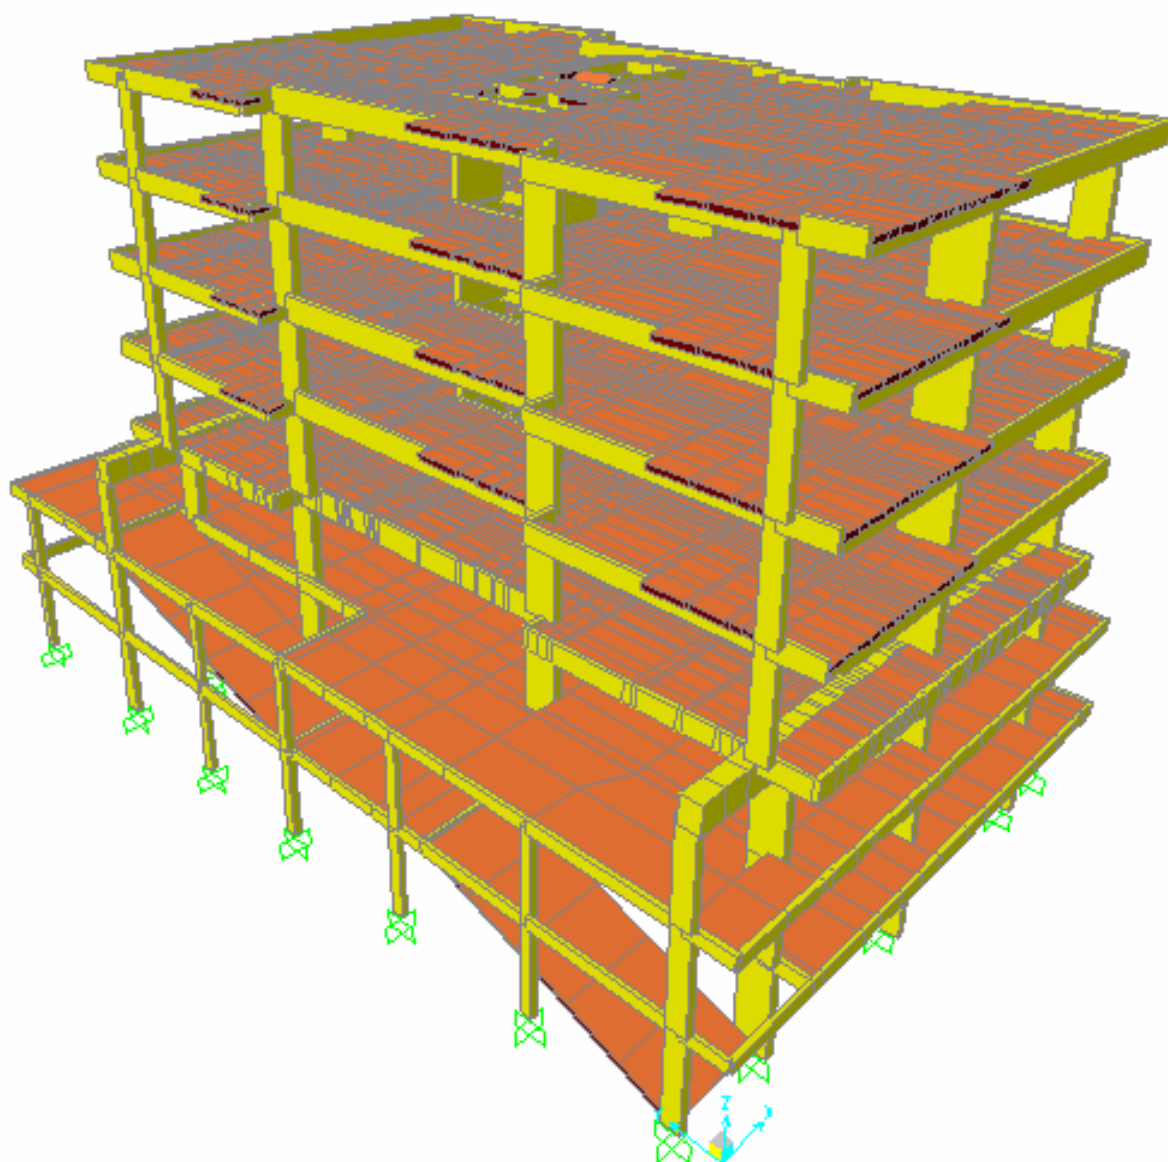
Modelo tridimensional da estrutura para a 7ª laje.
